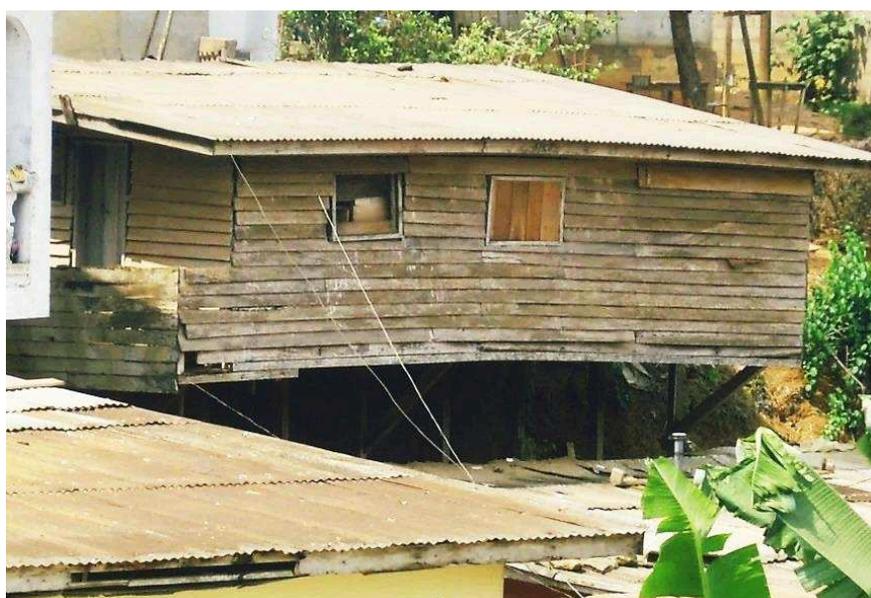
Vue d'une maison d'habitation dont les murs et le sol sont construits en planches dans le quartier Etoa-Meki
